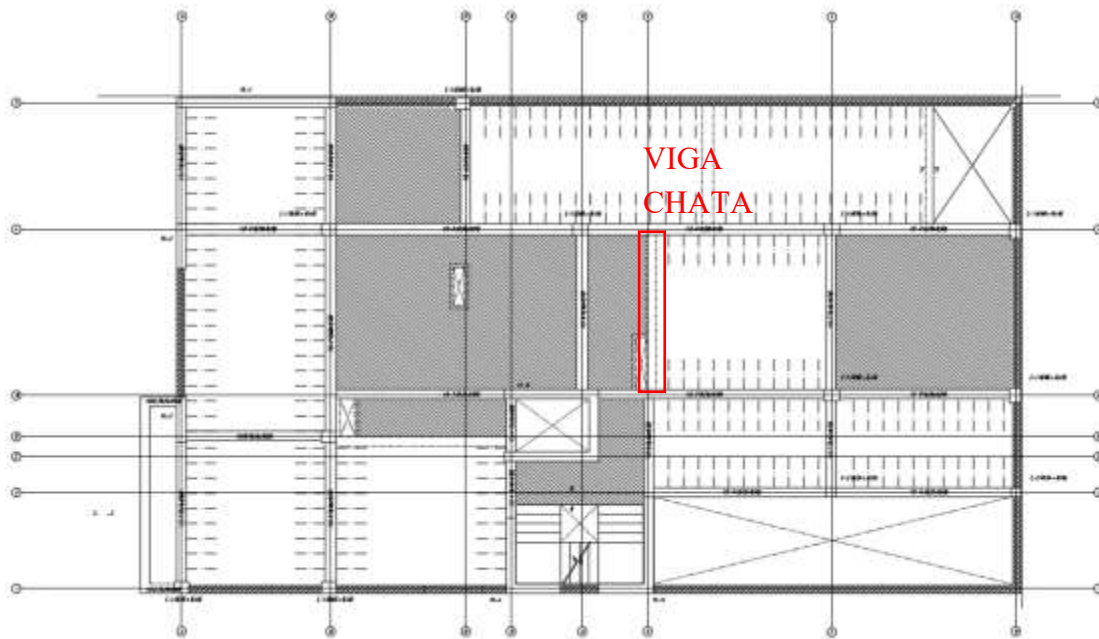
Ubicación en planta de la viga chata a diseñar
